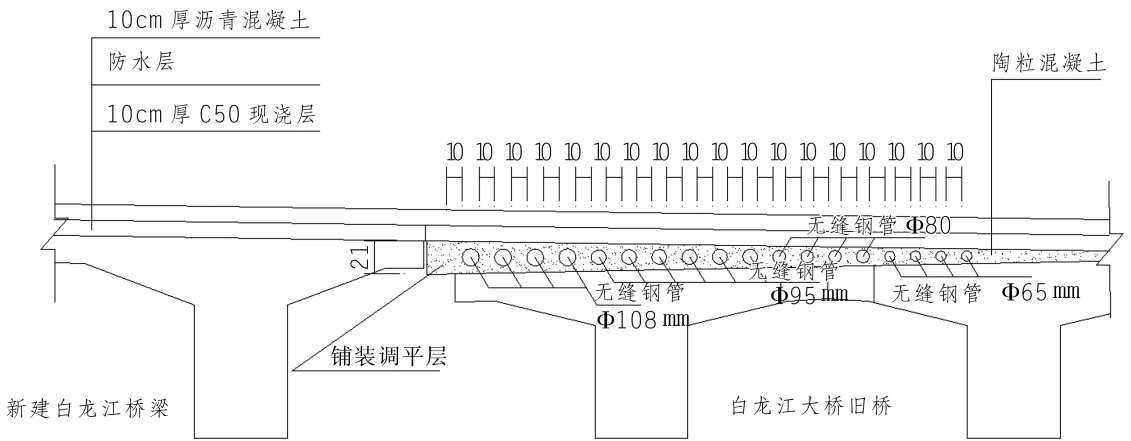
无缝钢管陶粒混凝土旧桥铺装调平层示意图
